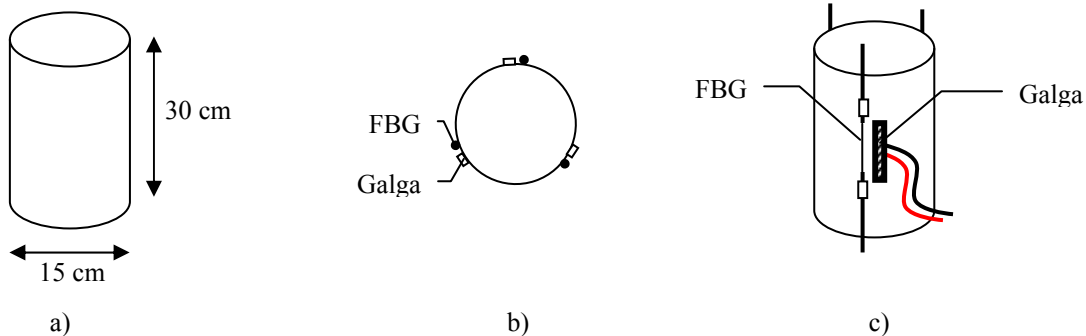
a) Dimensiones de las probetas cilíndricas de hormigón. b) y c) Colocación de los sensores.
